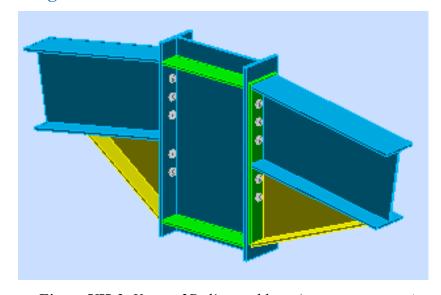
Vue en 3D d'assemblage (traverse-traverse)
